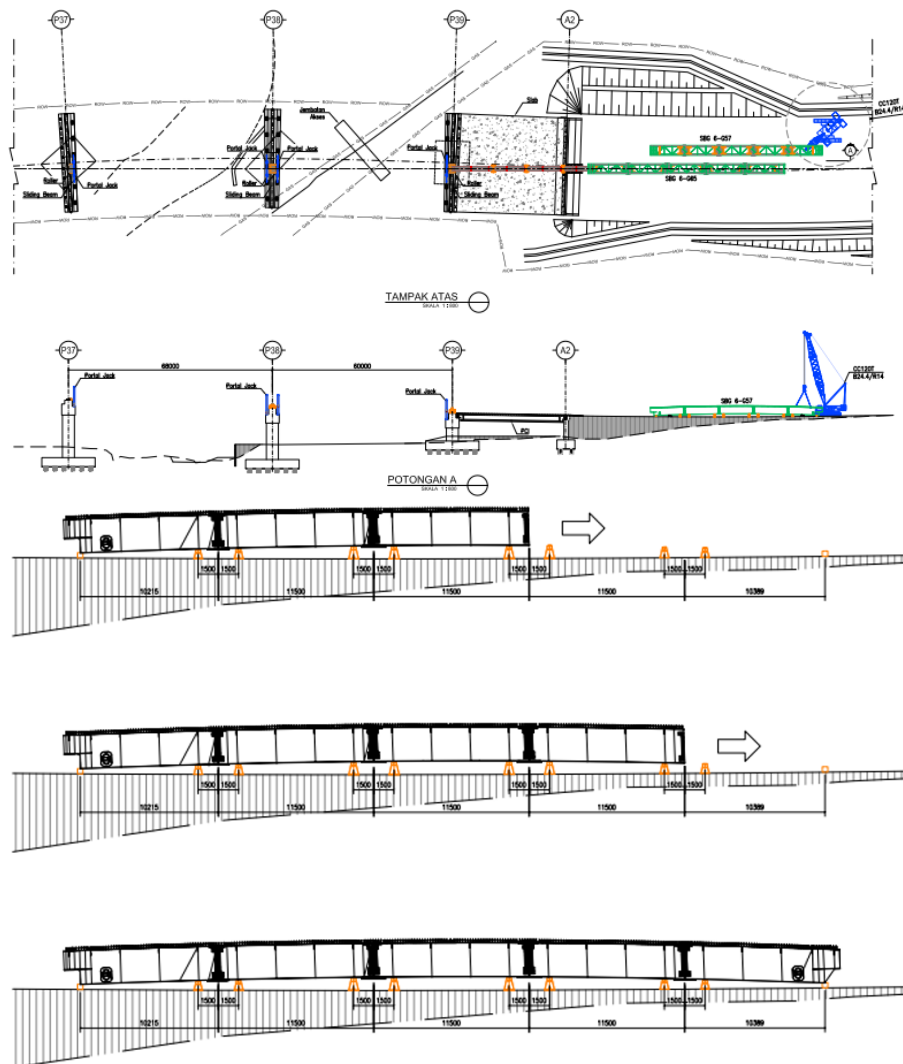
Ilustrasi Pemasangan *Steel Tub Girder* 65 m
